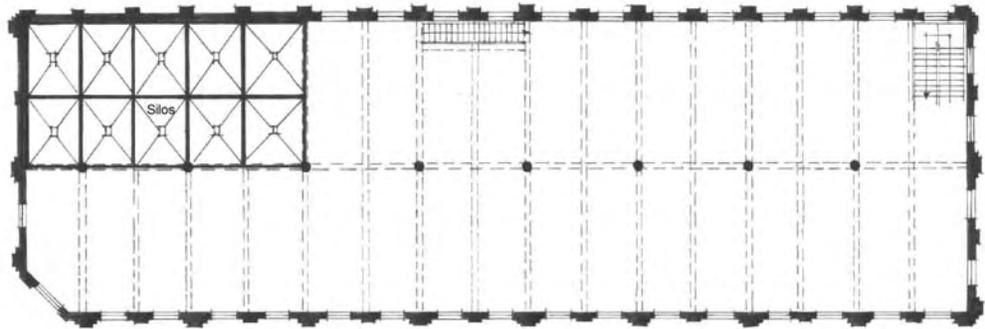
Plantas baixas Moinho Chaves, Theo Wiederspahn, 1920. Estrutura em concreto armado e planta livre.
